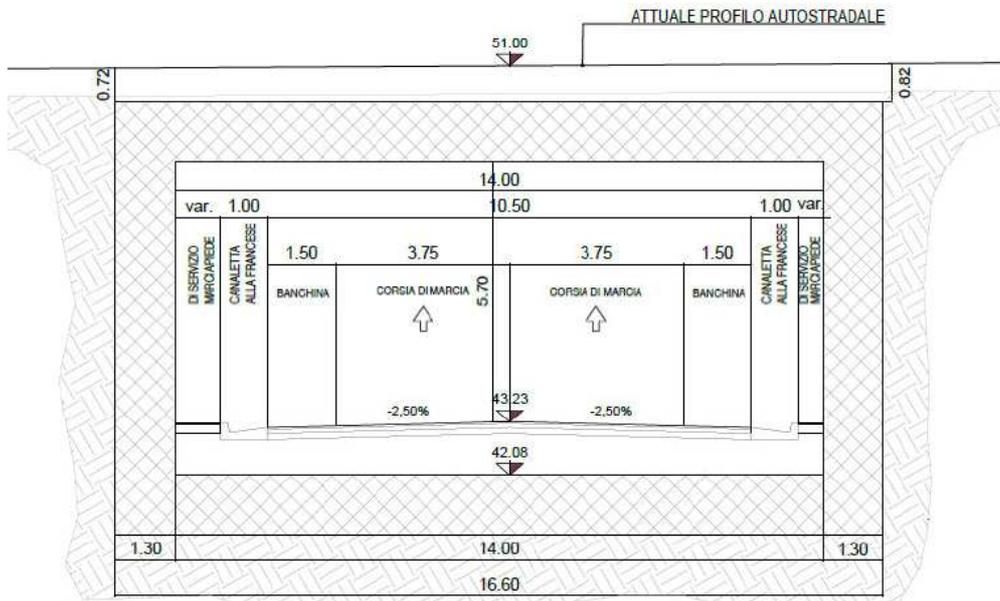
Sottovia A14 – Sezione trasversale tipologica (Soluzione 1)
